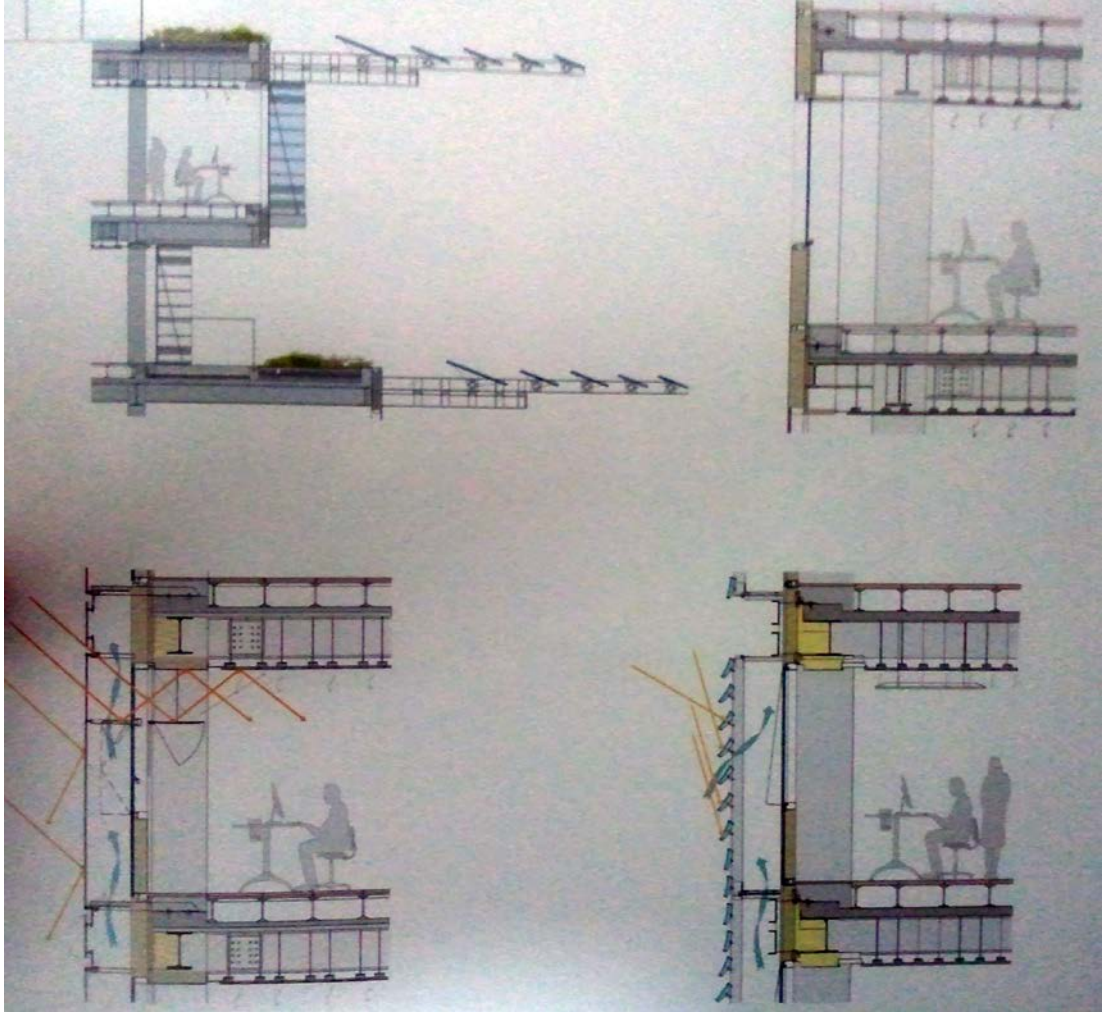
SIEEB Plan (Guzowski, 2010)
